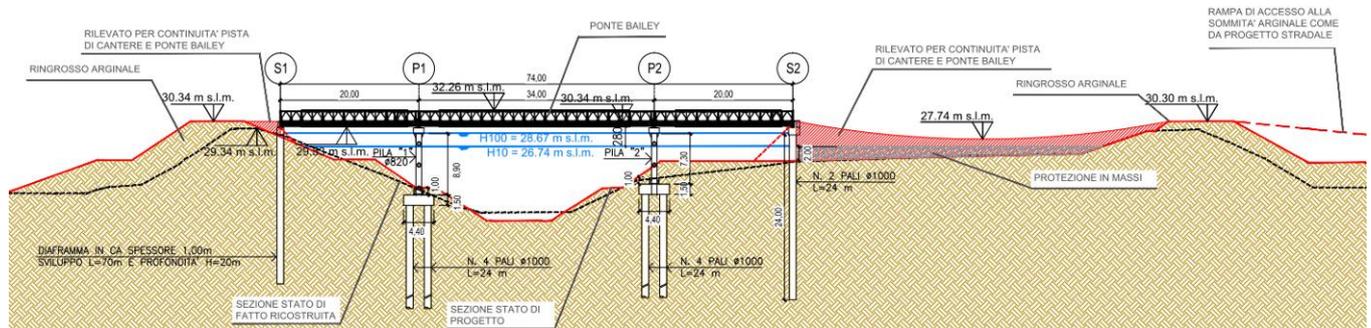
SEZIONE LONGITUDINALE CON UBICAZIONE DEL PONTE "BAILEY" IN CORRISPONDENZA DEL FIUME SECCHIA
